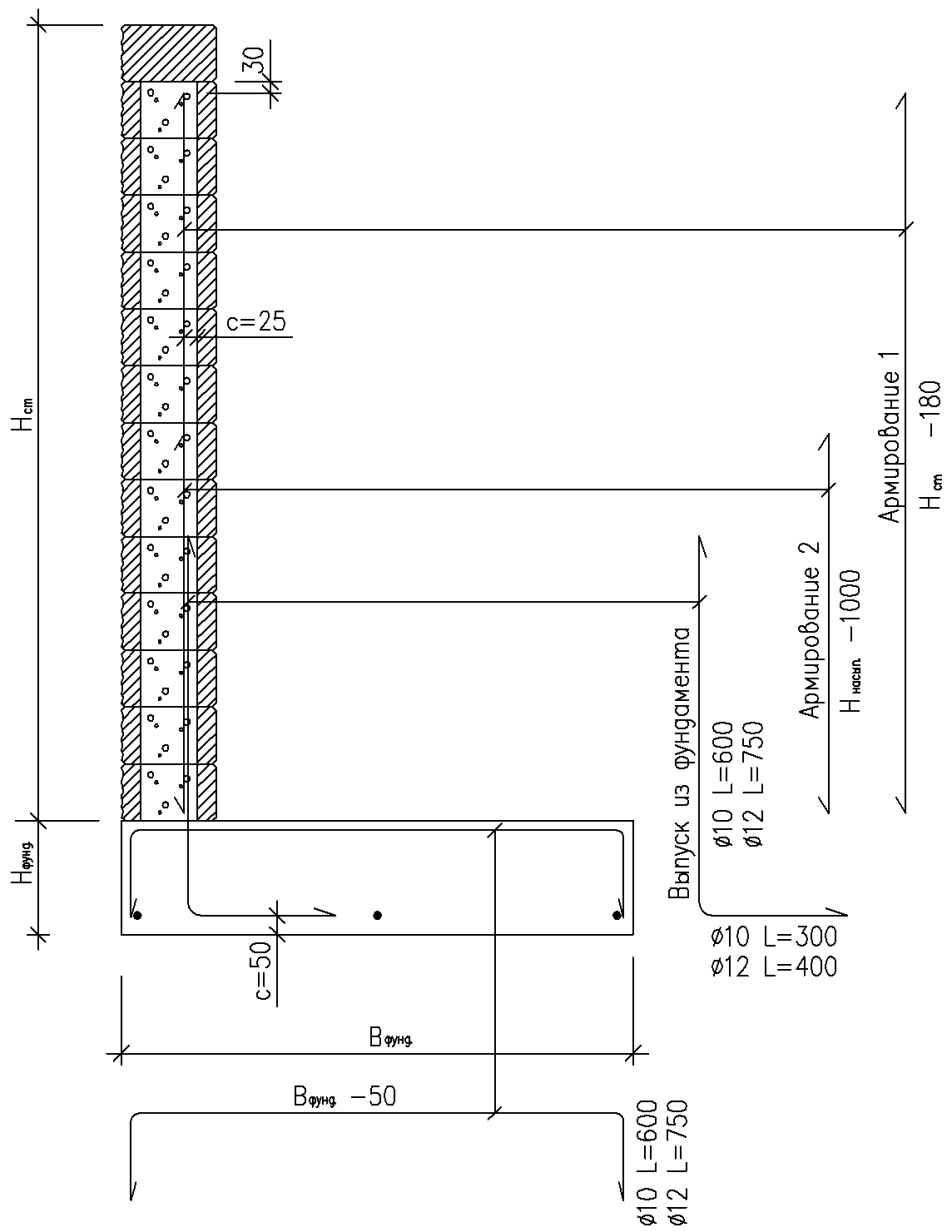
Армирование высокой стены из блоков ЛаммиМуури
